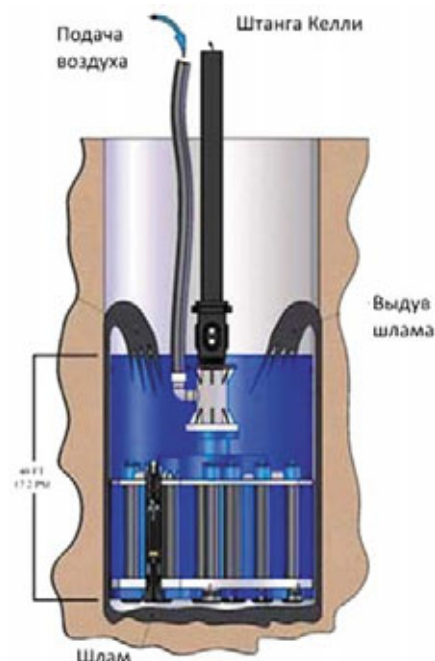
Кластерные пневмоударники с корзиной для сбора шлама
